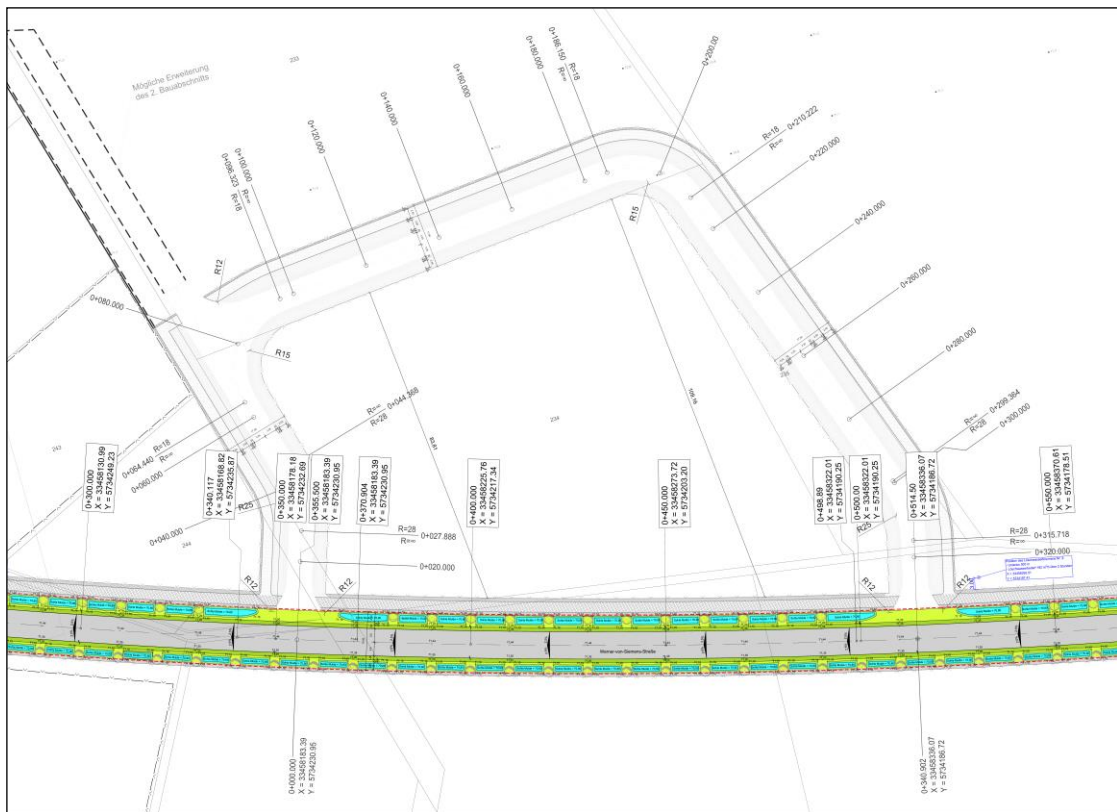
Straßenplanung (Erweiterung innere Erschließung) Werner-von-Siemens-Straße (Quelle: ARCUS Planung + Beratung)
